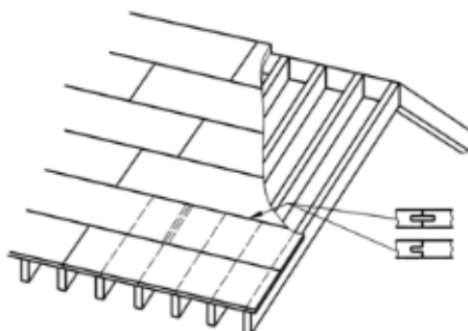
Pose des panneaux sur trois appuis et plus, transversaux
